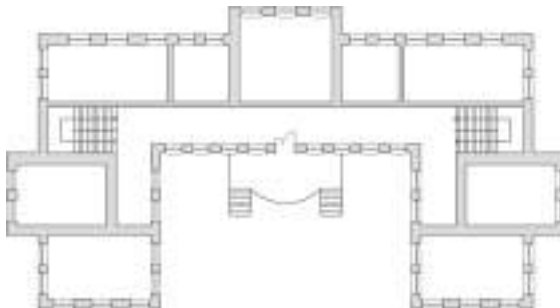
Konya Sanayi Mektebi Kat Planı
